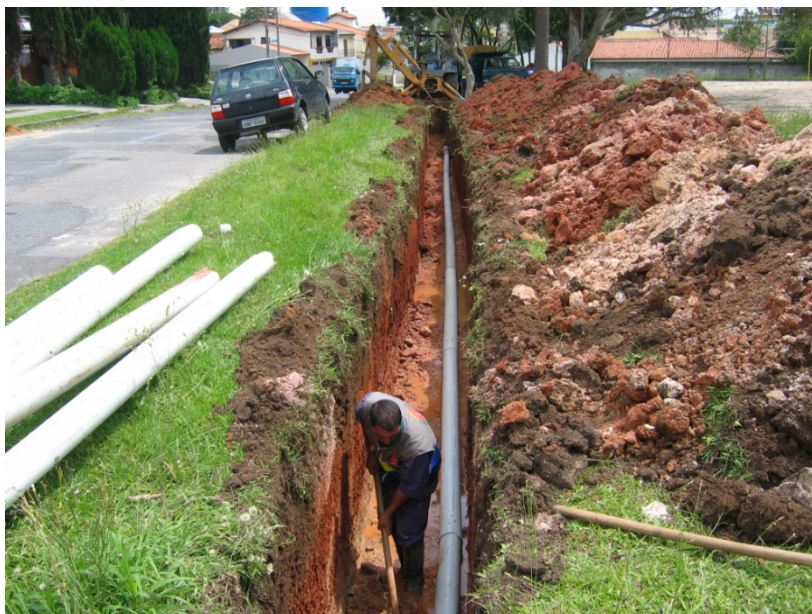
sistema de retenção e infiltração independente tipo vala de infiltração
